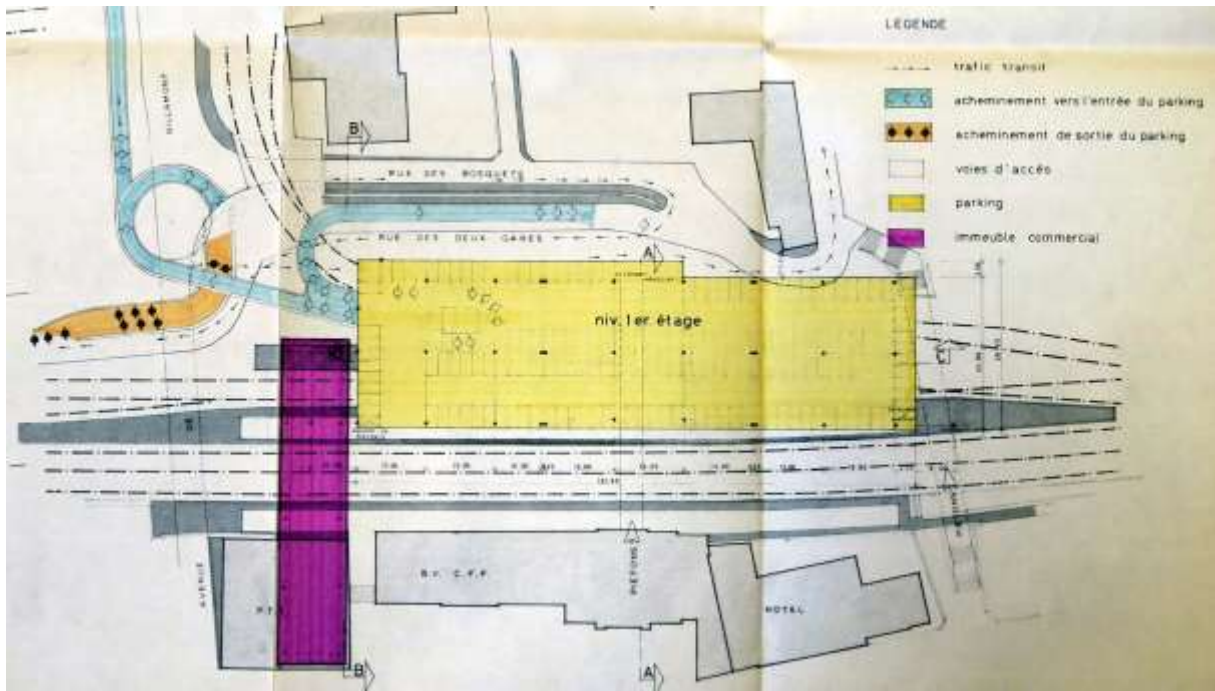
Projet de parking sur les voies de chemins de fer, plan, Groupe 3, mars 1972 (AV 91.01.II).
